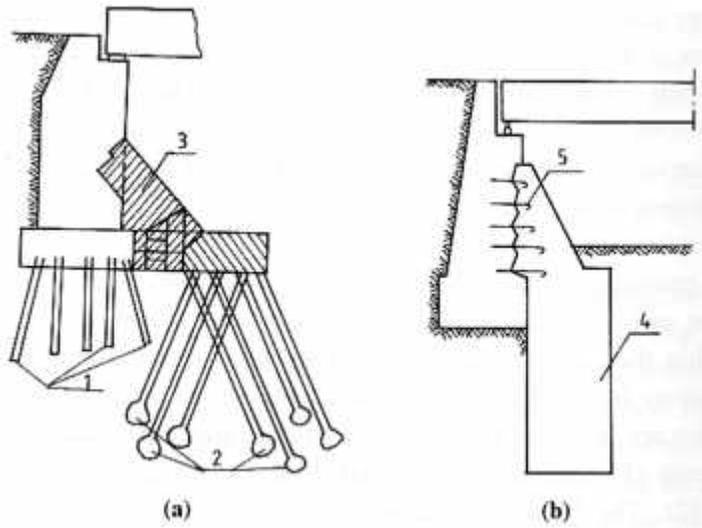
Perlindungan kepala pilar dari pergerakan horosontal dengan reinforced concrete strut
